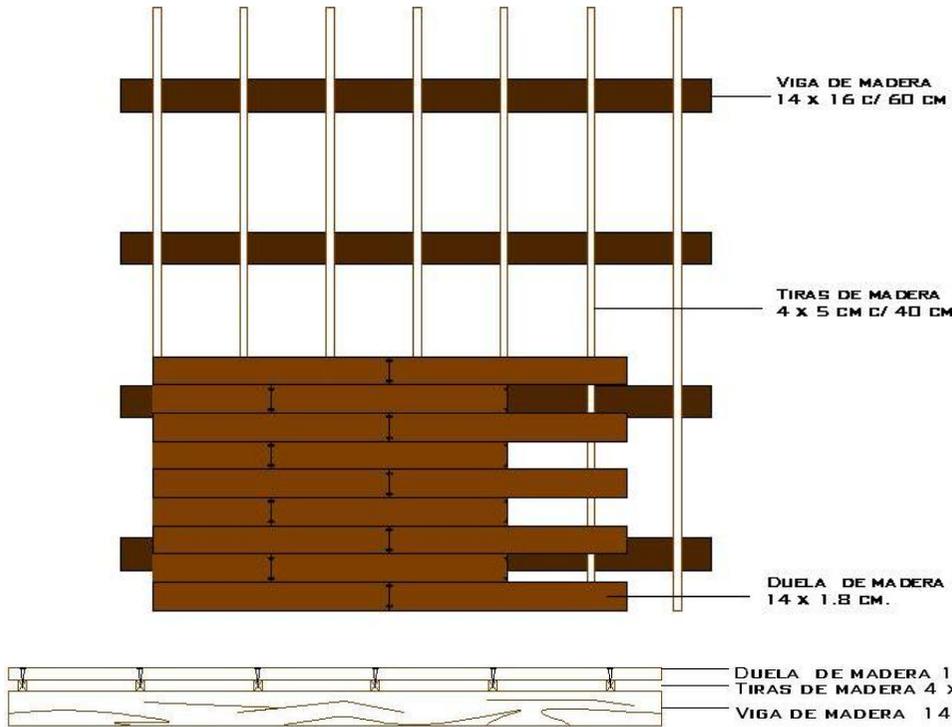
PISO DE MADERA SOBRE ENVIGADO DE MADERA
